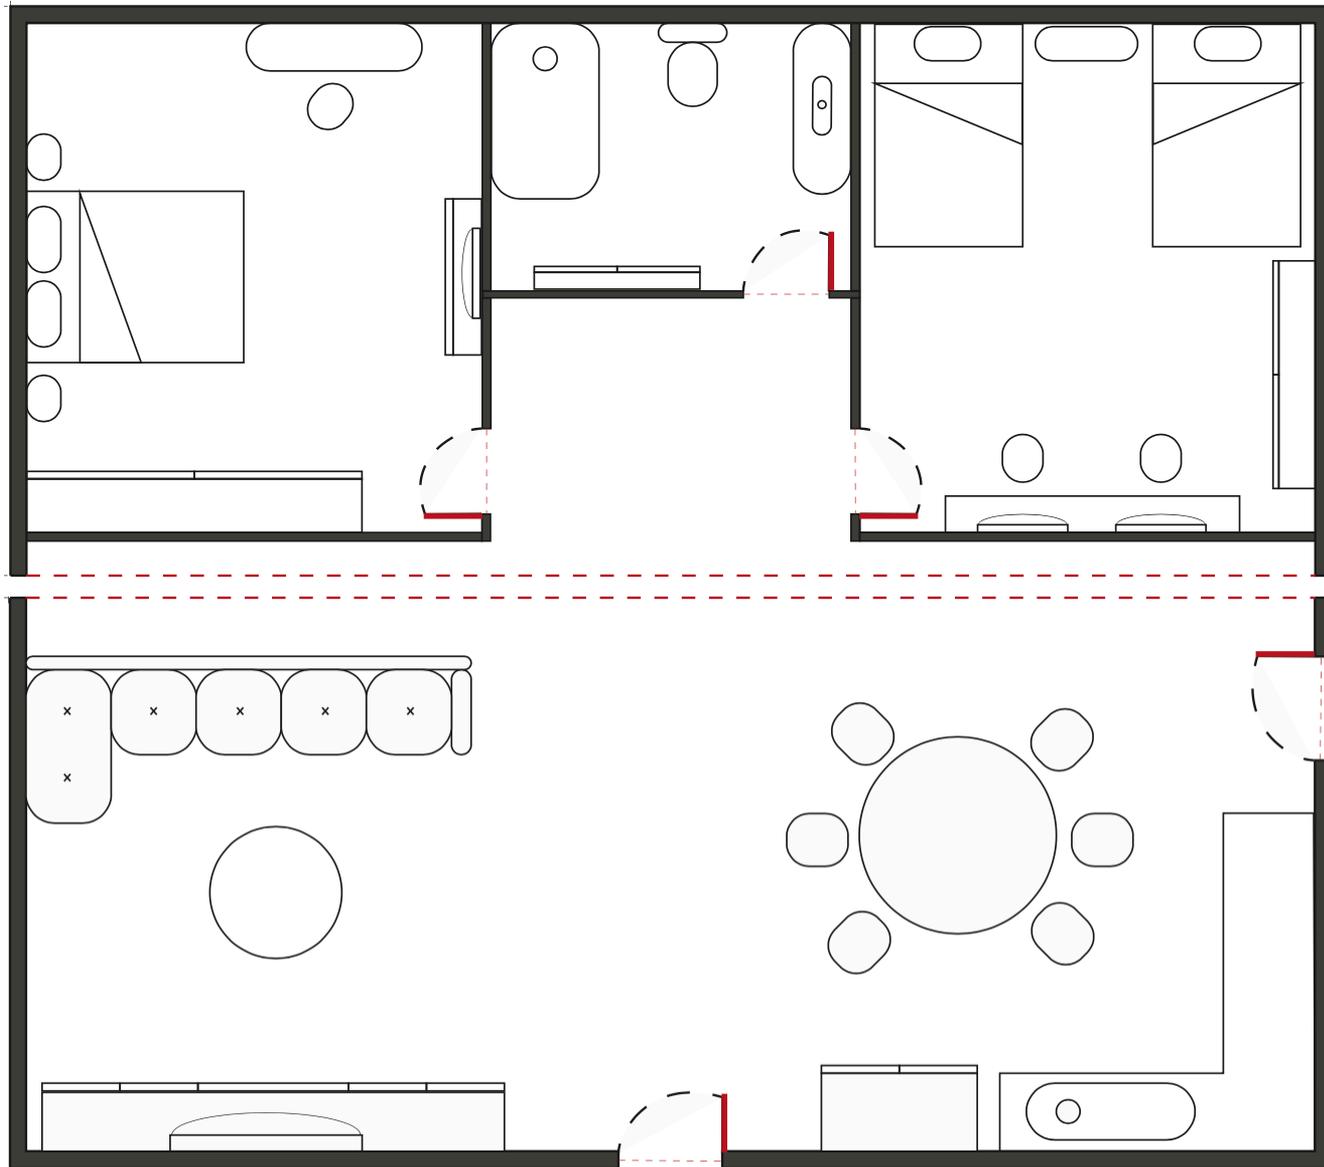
Planos para vivienda de módulo doble. Fuente: autoría propia.
